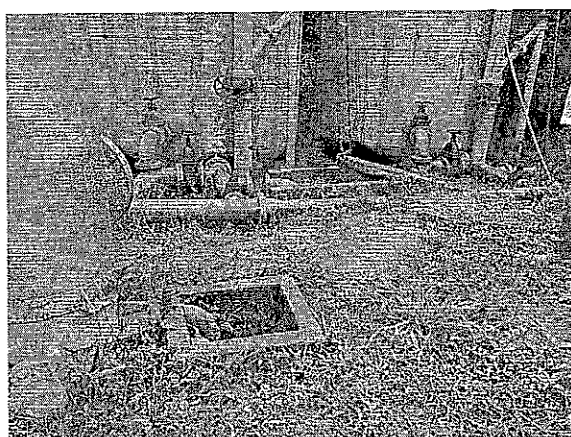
Caixa de inspeção sem tampa e com excesso de vegetação.
